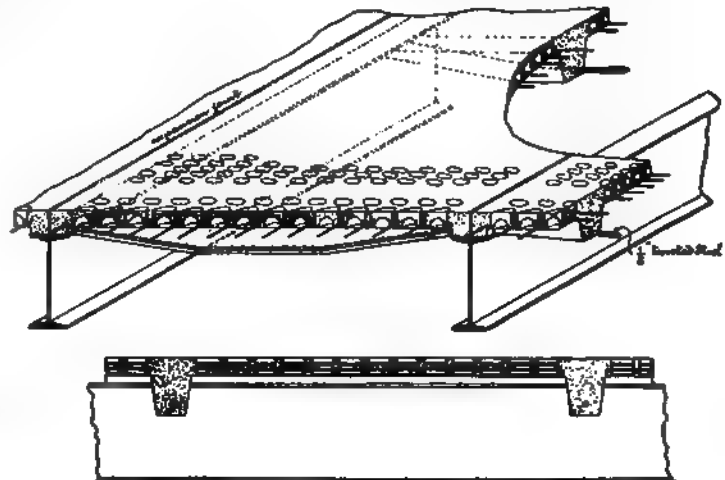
Glasdecke der Untergrundbahn in New-York.
